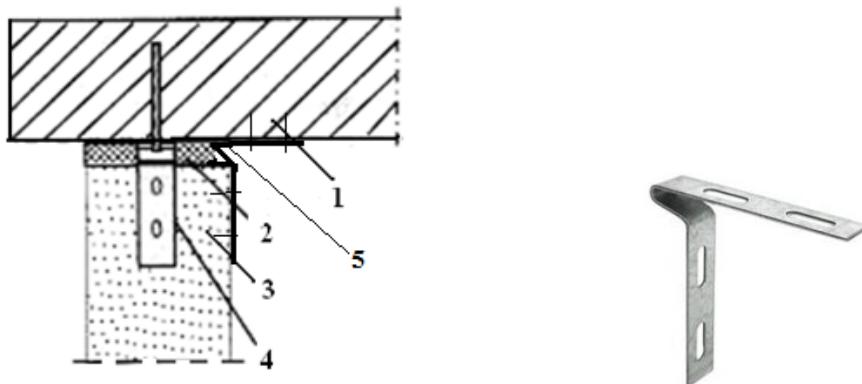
Крепление облицовочного и внутреннего каменных слоев к колонне каркасного здания, с элементом крепления
